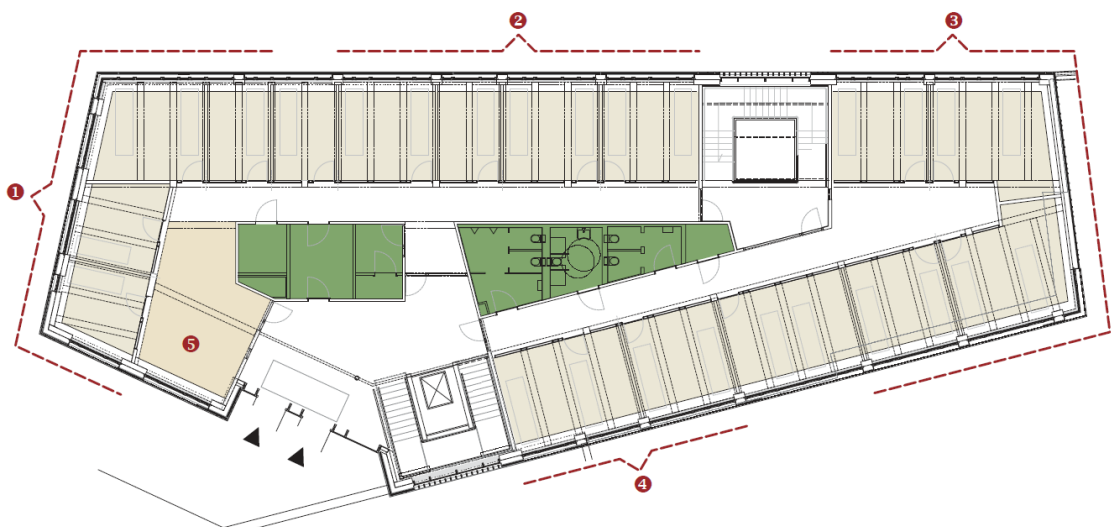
Grundriss Eingangsebene – Kernzone und Büroraumzone mit Zuordnung der Abteilungen
